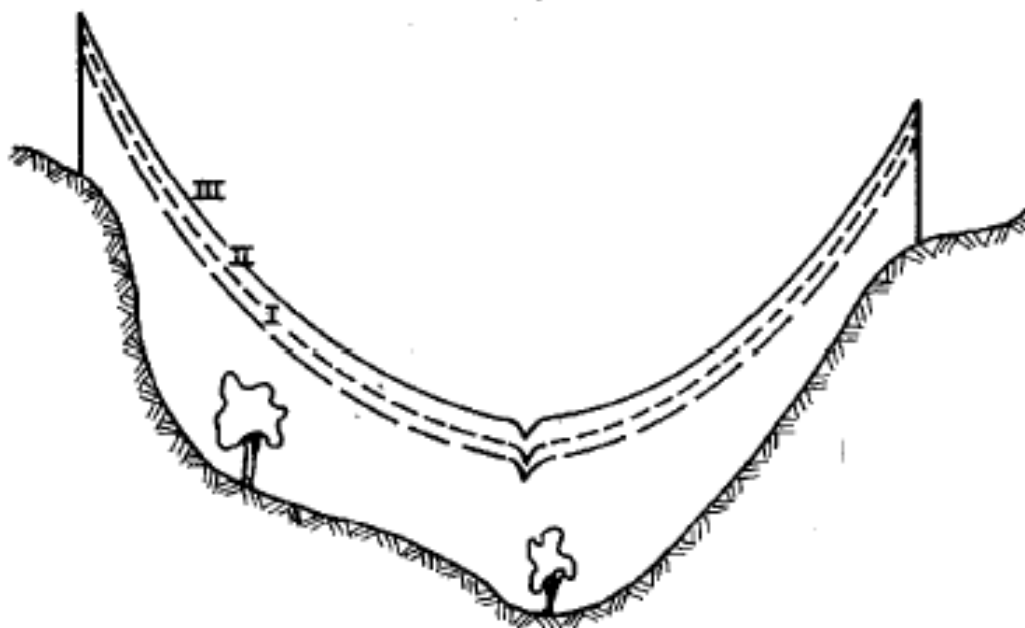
Esquema para limpeza da Faixa de Servidão - Corte longitudinal
